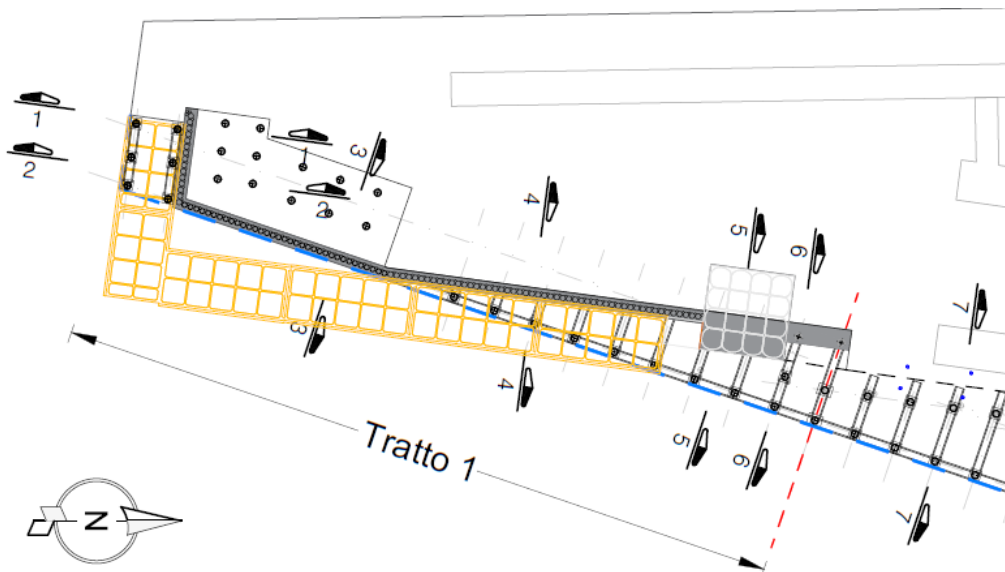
Planimetria di intervento – Tratto 1 con indicazione dei cassoni da salpare (giallo) e esistenti (grigio)
